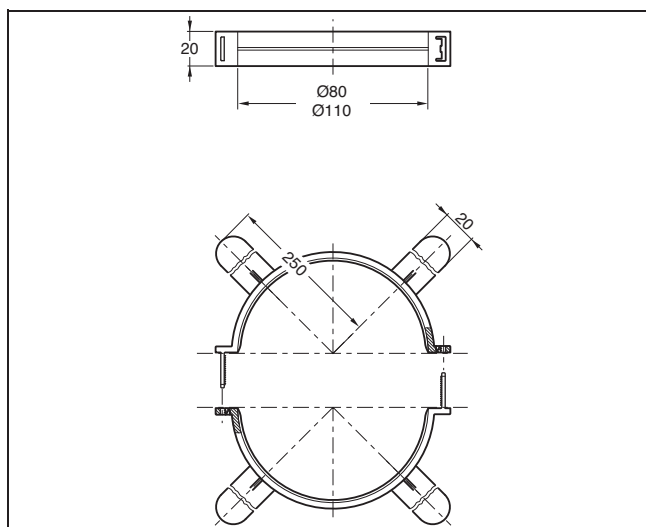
Kryt šachty pro 80 mm (rozměry v mm)
